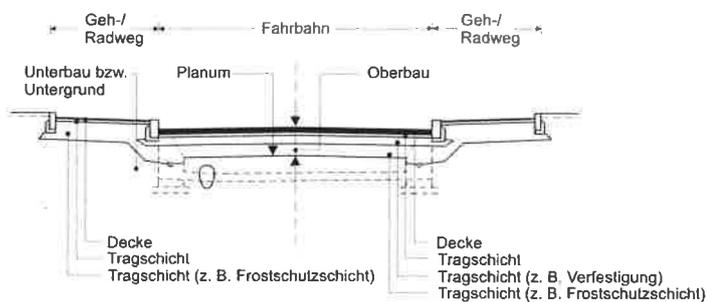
Beispielhafter Aufbau einer Befestigung in geschlossener Ortslage mit teilweise wasserundurchlässigen Randbereichen sowie mit Entwässerungseinrichtungen
